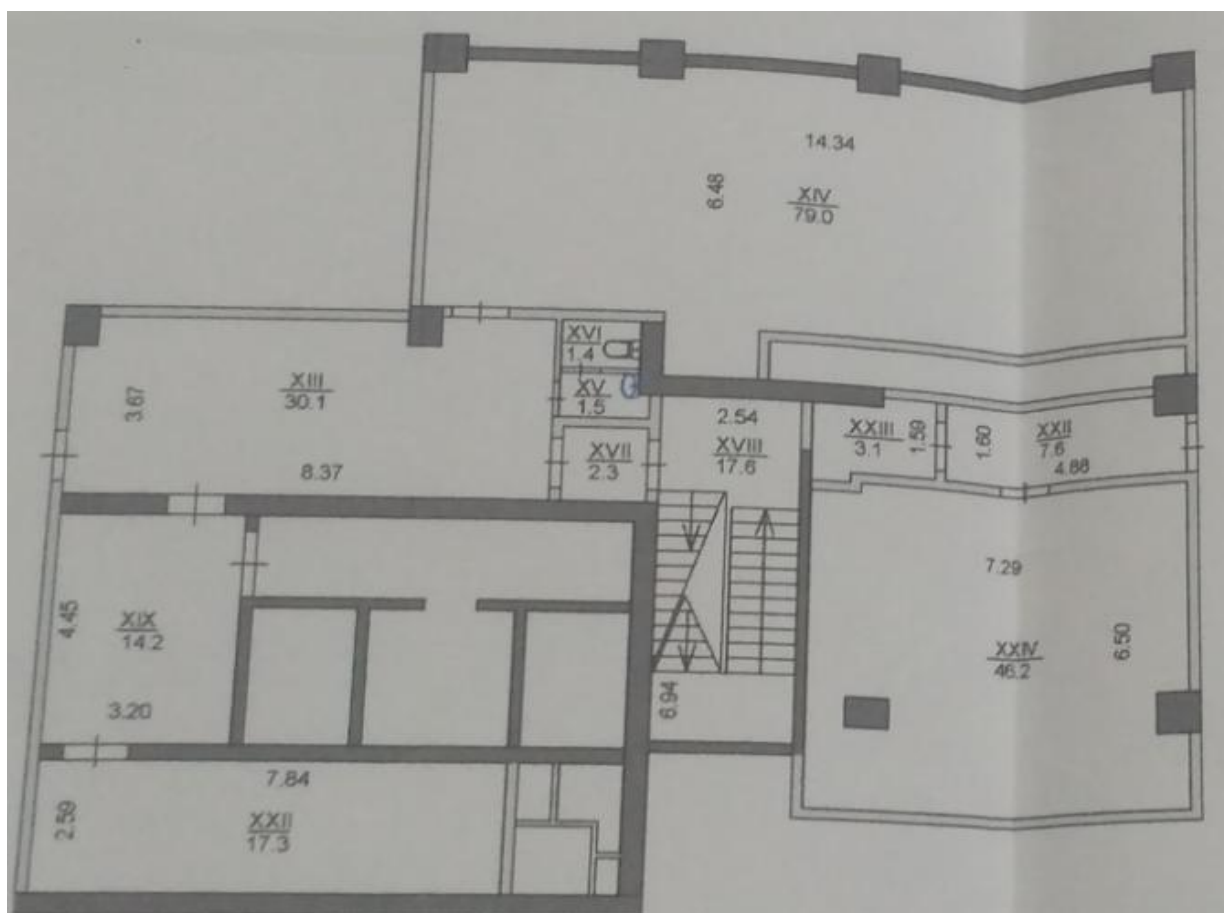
План цокольного поверху будинку за адресою вул. Західна 10
